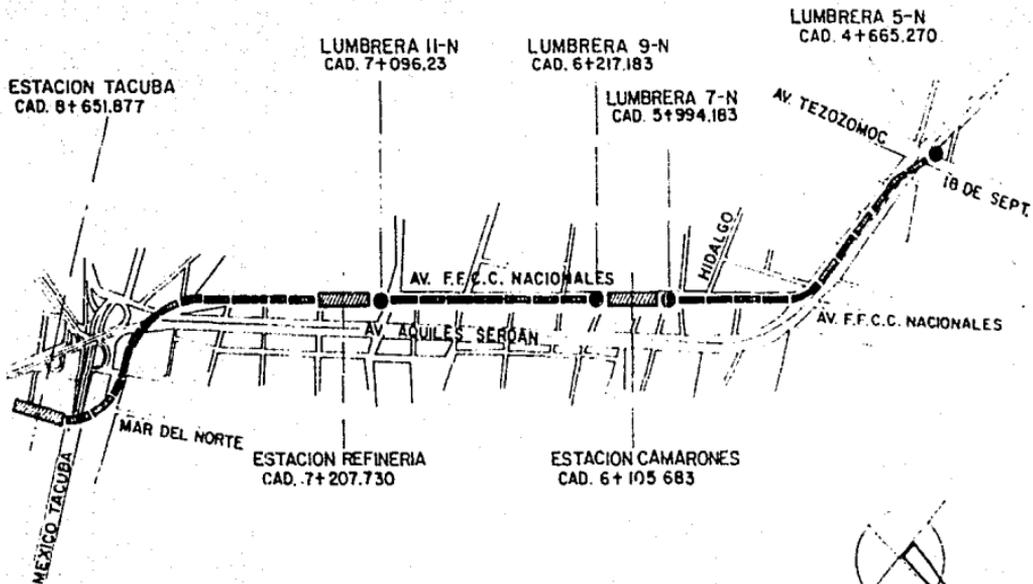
PLANTA DE TRAZO DE LA LINEA 7N-N MOSTRANDO LOS TRAMOS DE TUNEL EXCAVADOS CON EL ESCUDO DE 9.513 M. Ø
